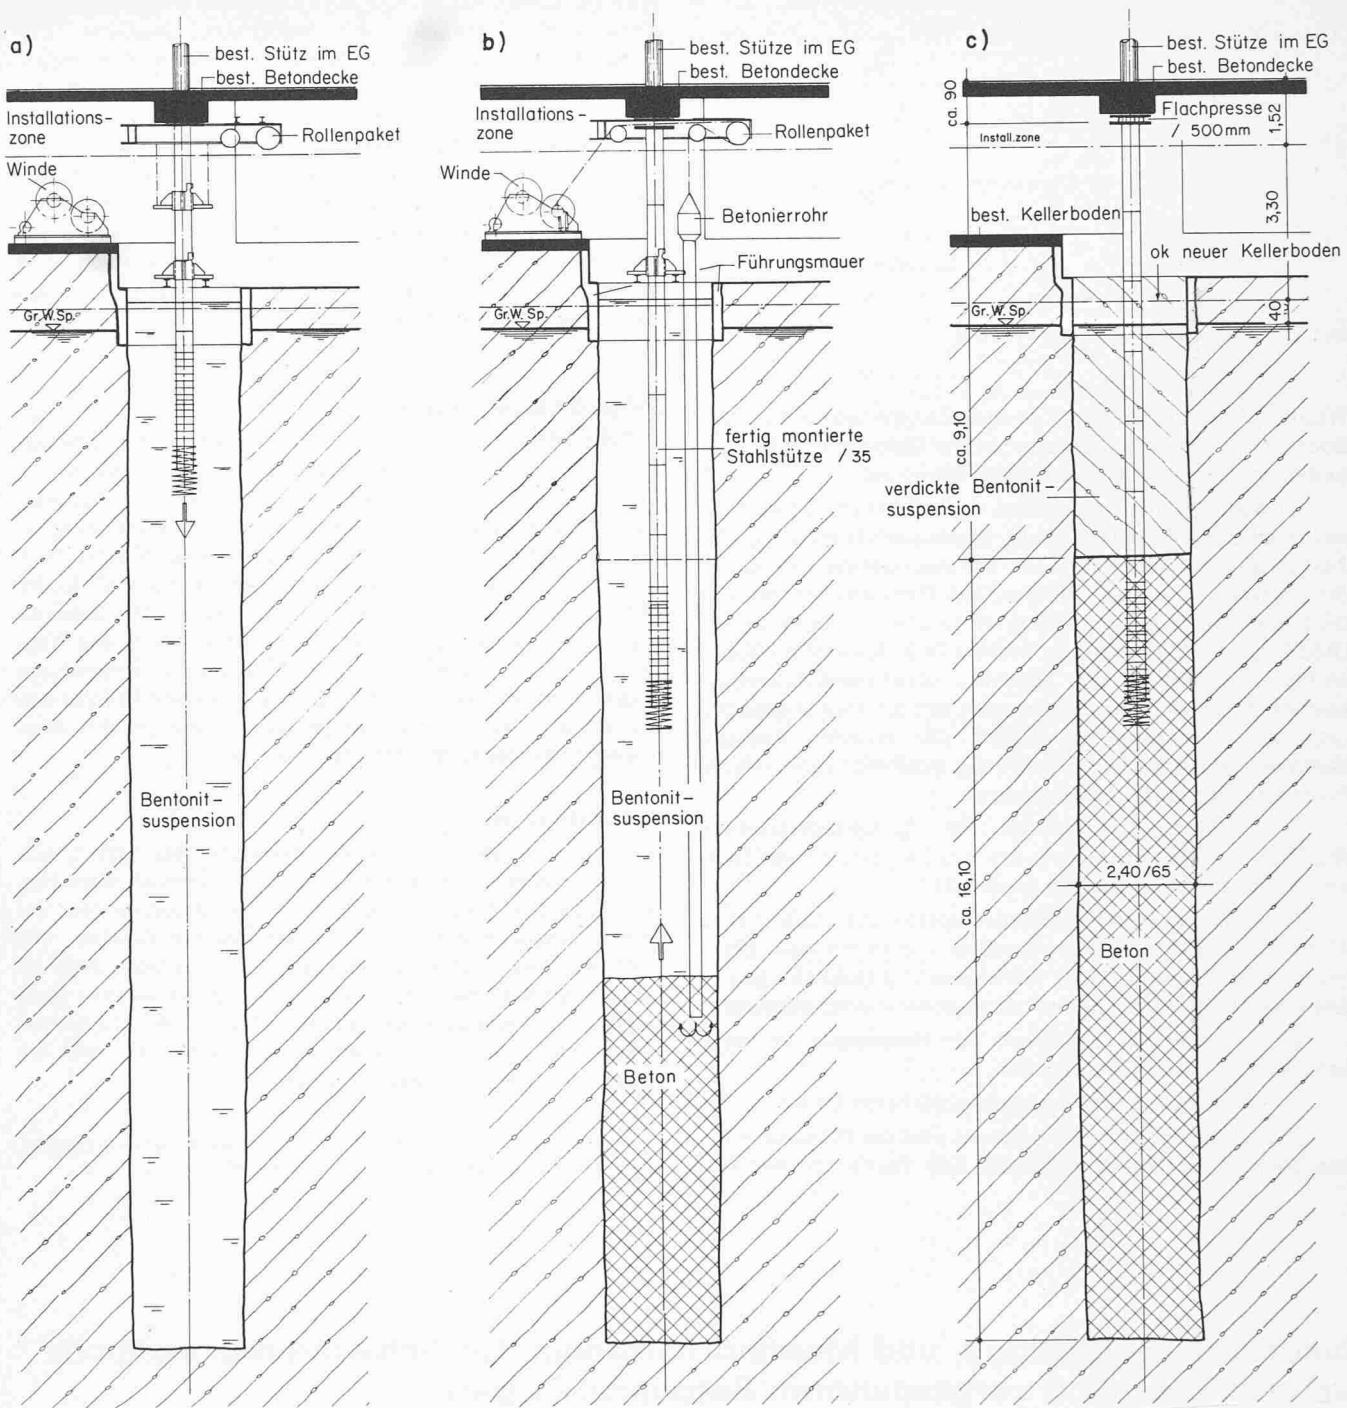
Einbau der Stützen. a) Stützenabsenkung b) Betonieren des Pfahles c) Fertiger Pfahl
